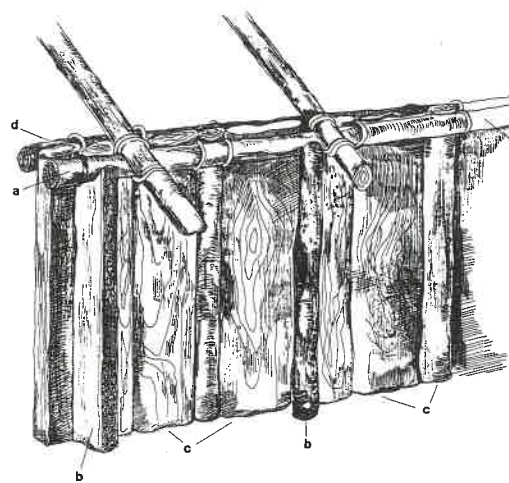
Rekonstruktionsversuch einer Spaltbohlenwand, mit Dachaufbau (nach Kuper 1979, Abb. 11) ergänzt.
